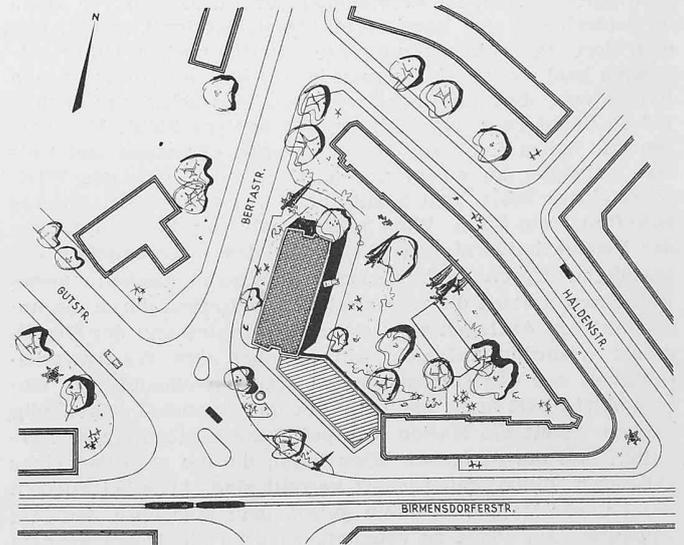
Ausgeführter Bau, Wohnblock an der Bertastrasse sechs-geschossig, Ladenbau ebenerdig
